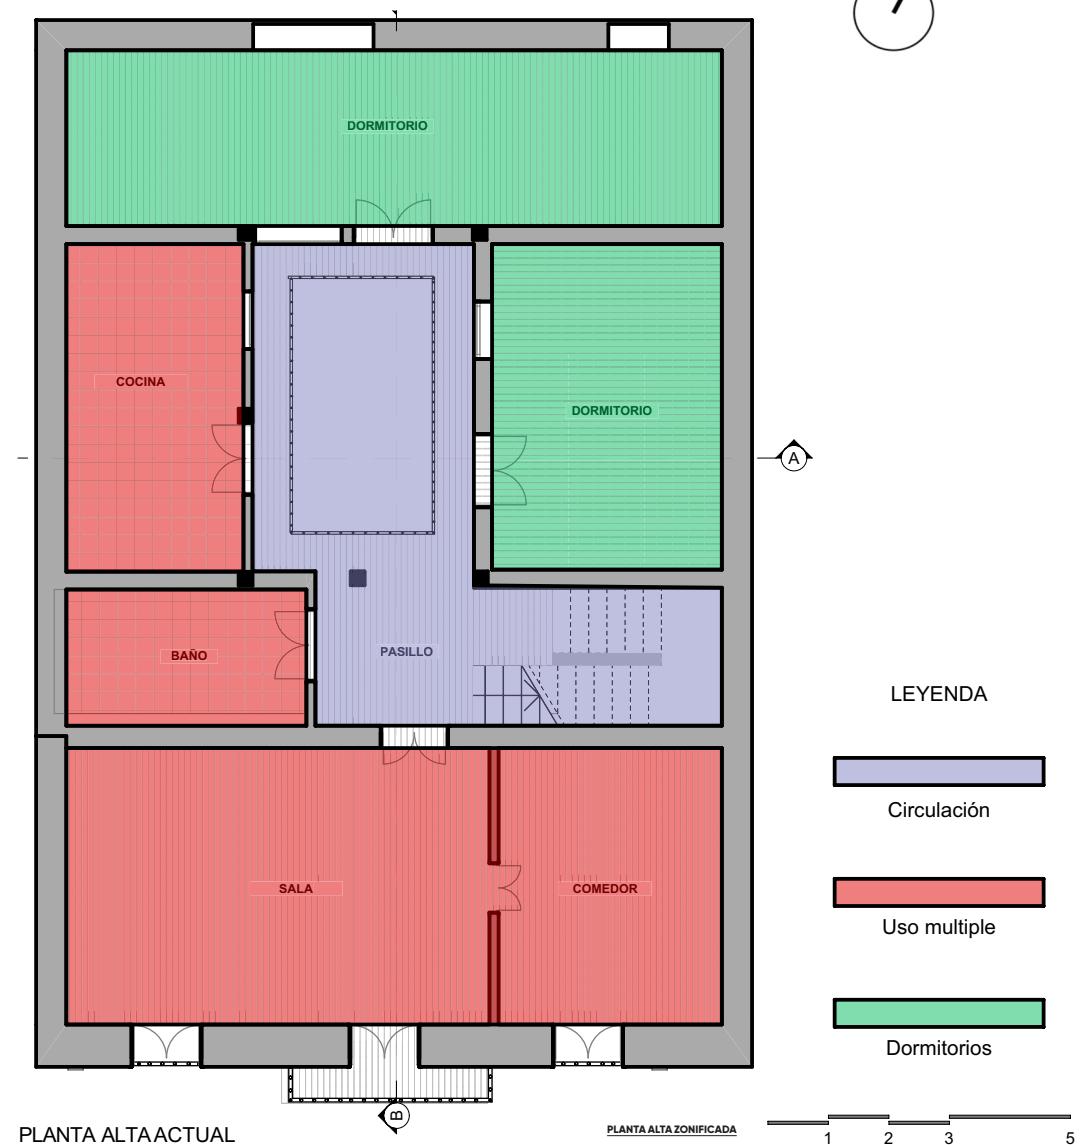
Ilustración. Planta Alta de Vivienda. Realizada por el autor
